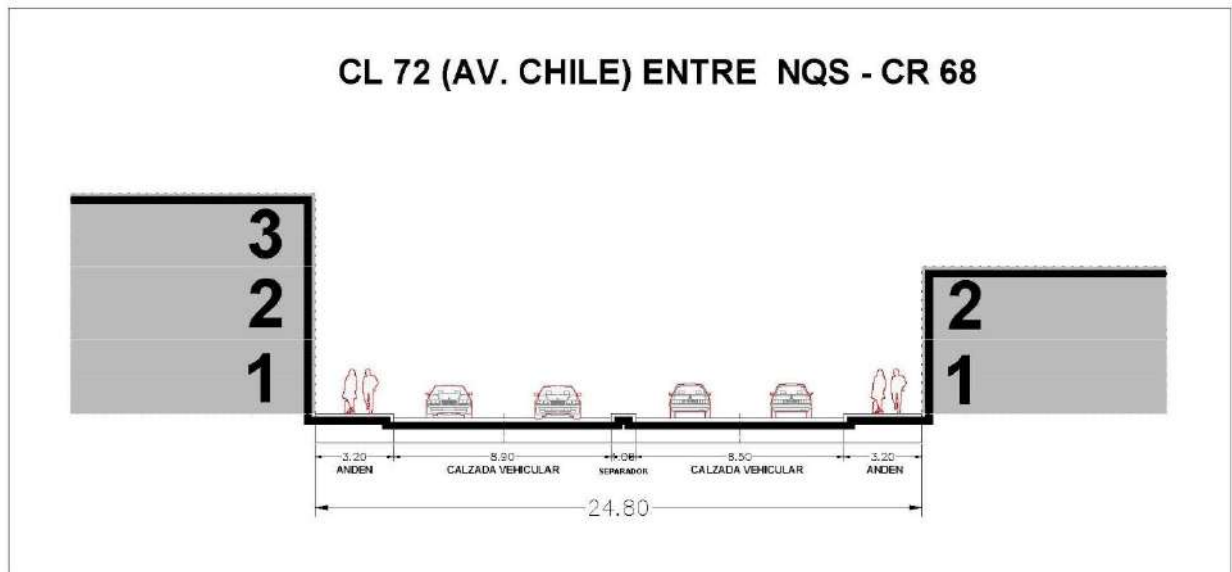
Perfil vial existente Calle 72 – tramo 1
